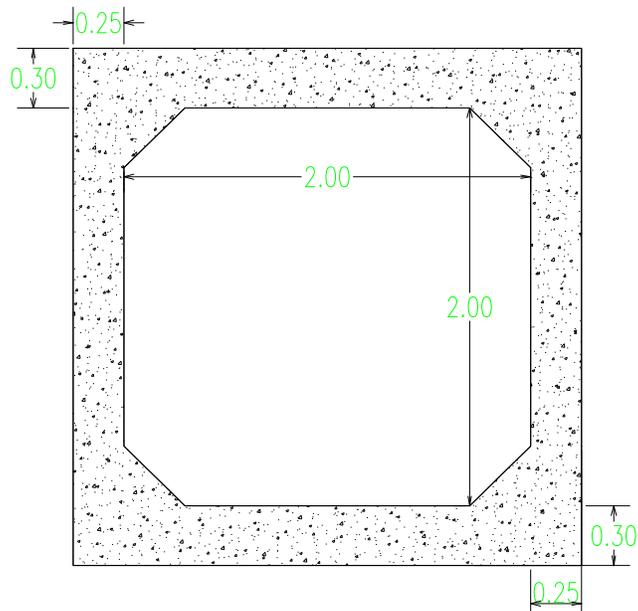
Sección Transversal de Box culvert. (Fuente: Pasante)
